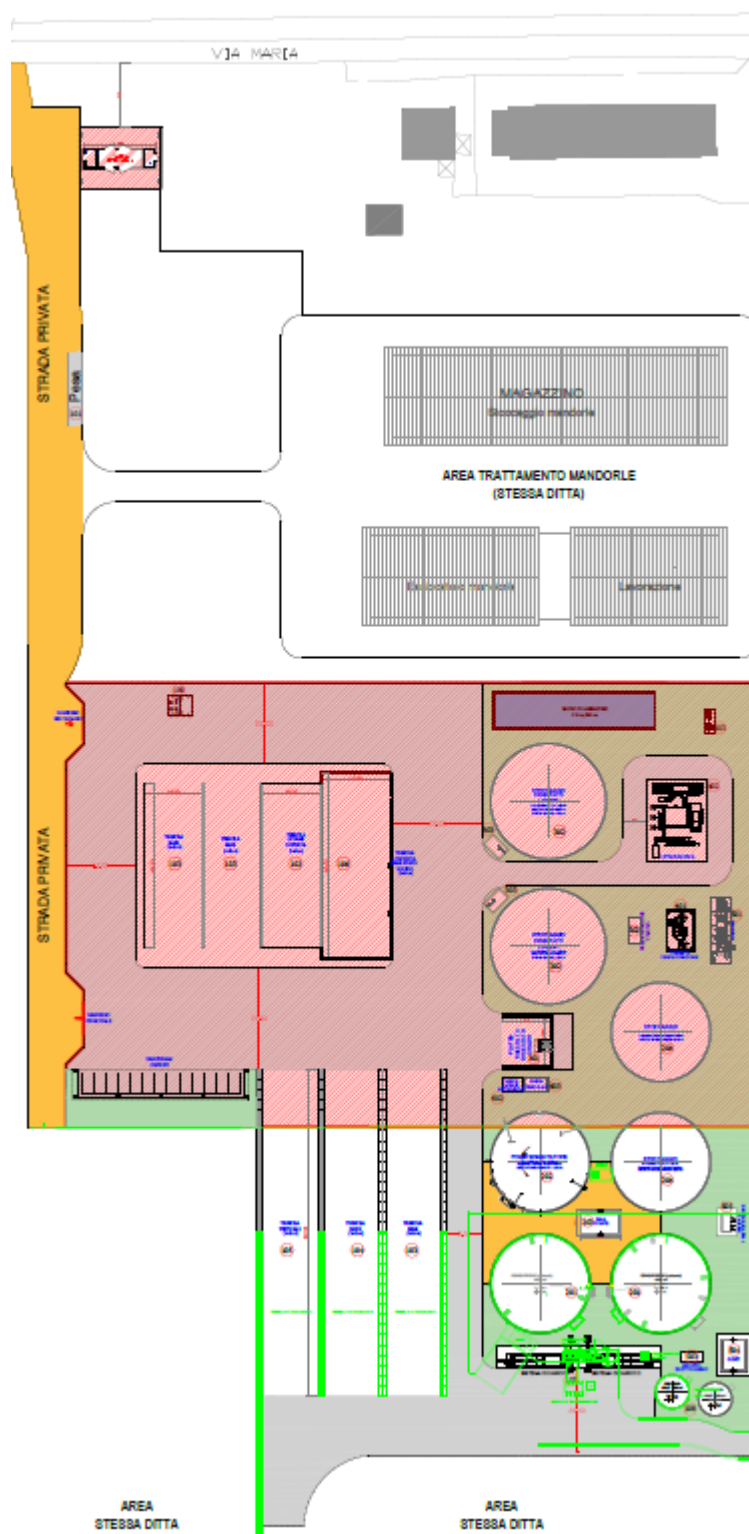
Sovrapposizione progetto rispetto a stato di fatto
